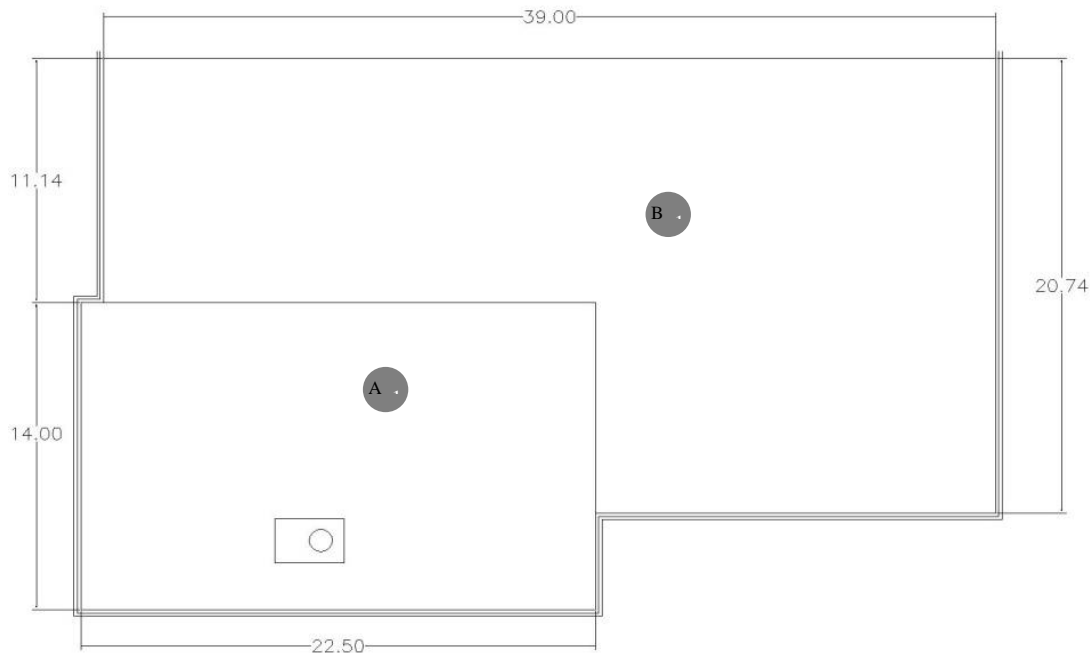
ejemplo de losas de contrapozo de una plataforma geotérmica. A) Losa de contrapozo y B) losa de equipos.
